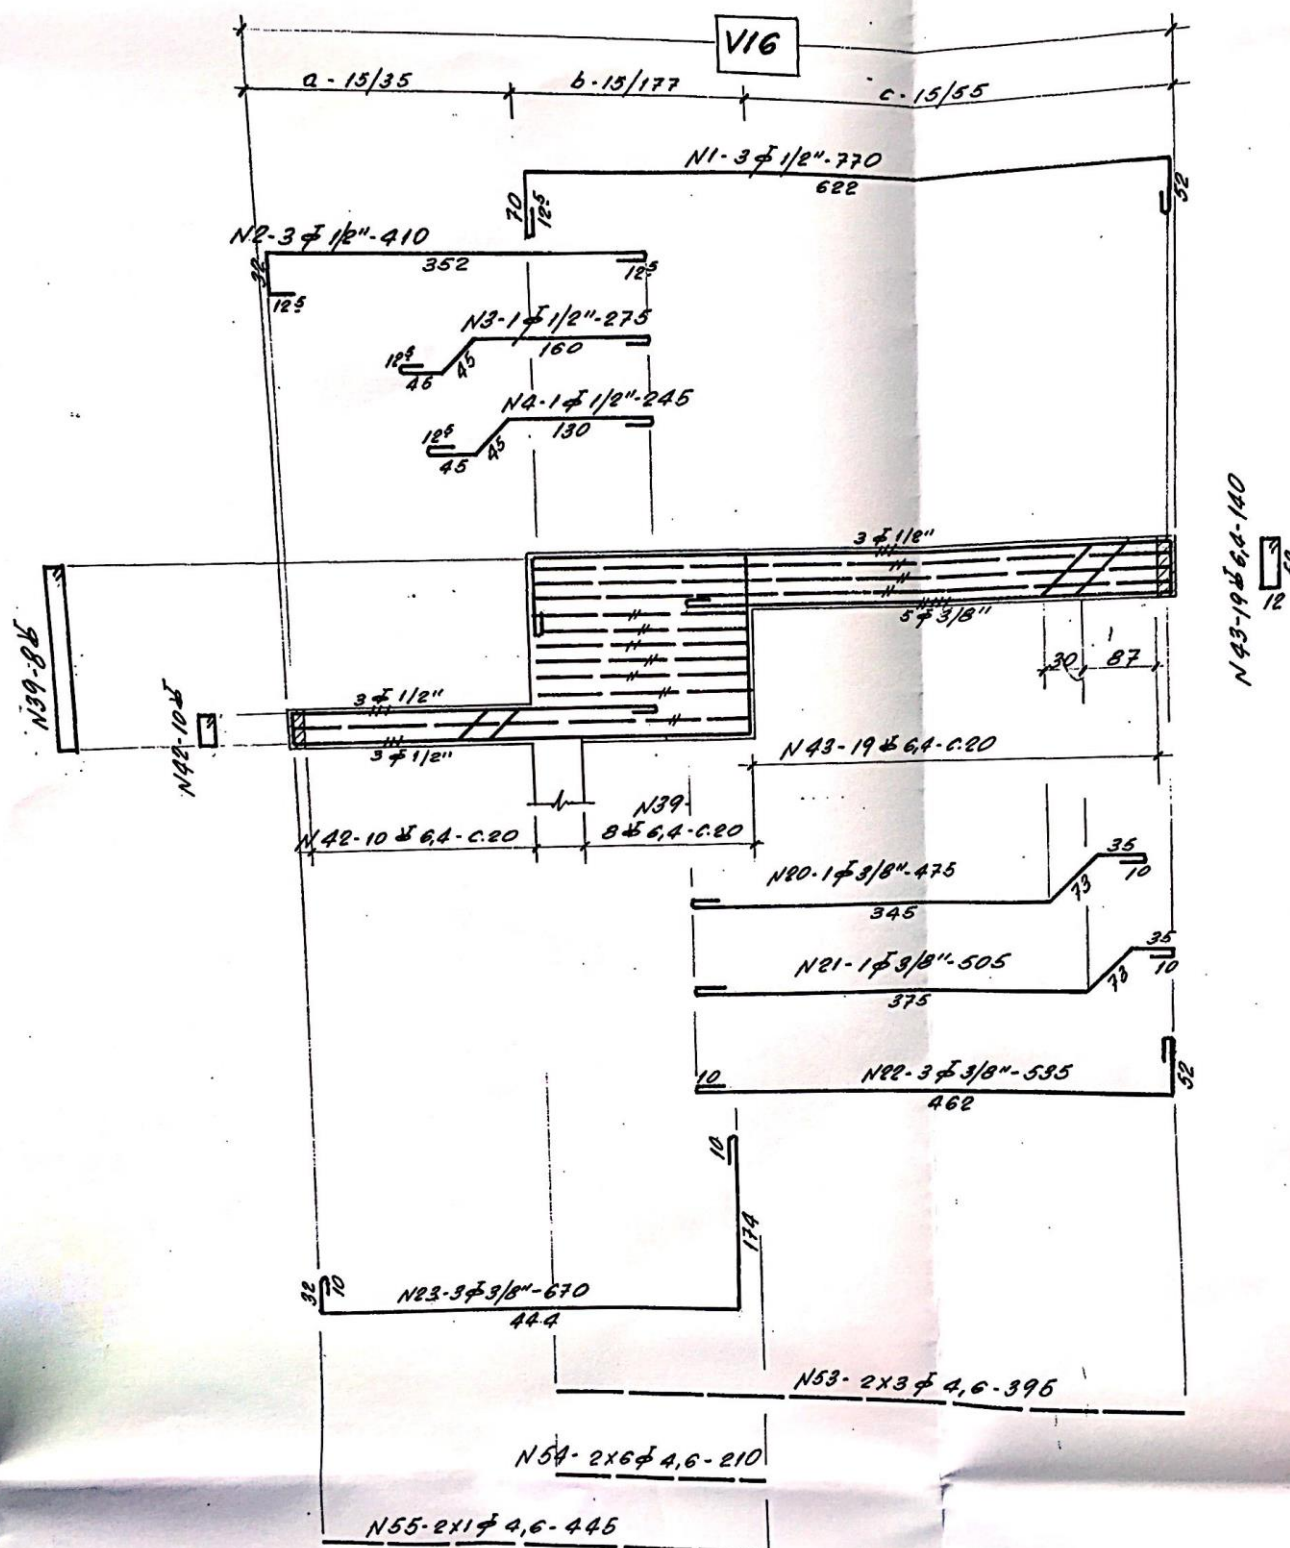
Det. de Armação da Viga da Cobertura - V16
